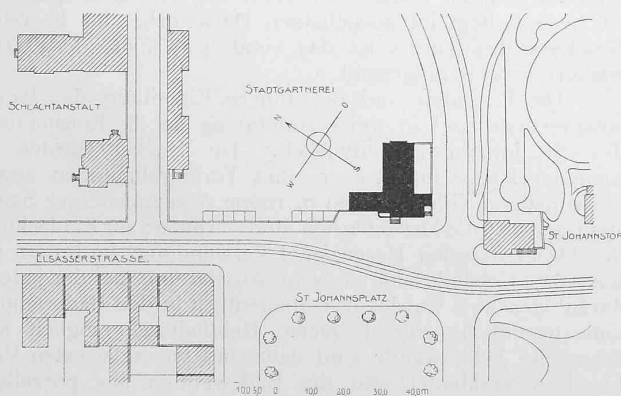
Lageplan der Brausebadanlage St. Johann in Basel.
